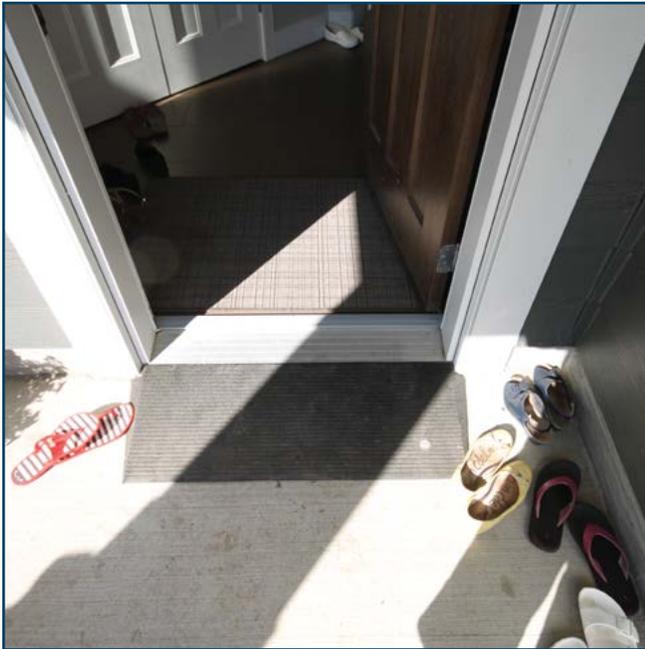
Rampe de seuil de porte en caoutchouc devant l'entrée extérieure
